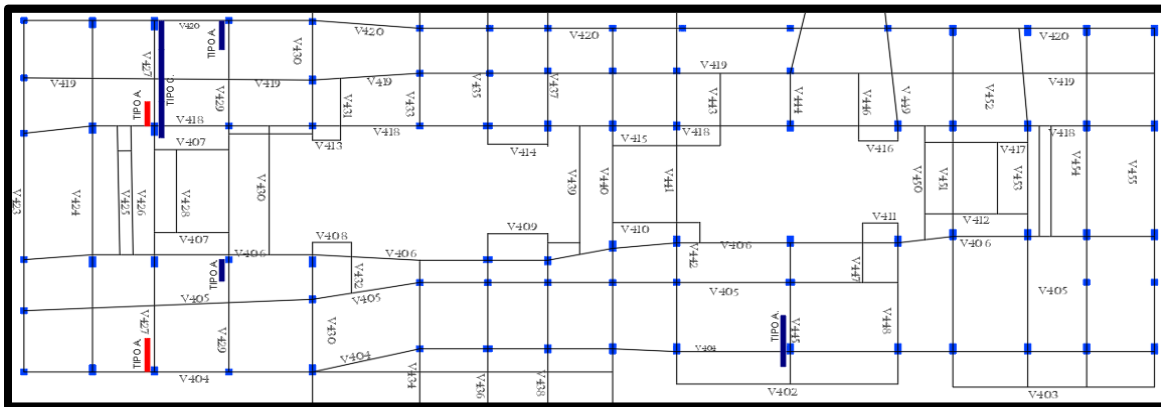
Muestra localización de zonas a reforzar en vigas con fibras de carbono. Fuente: Los autores
